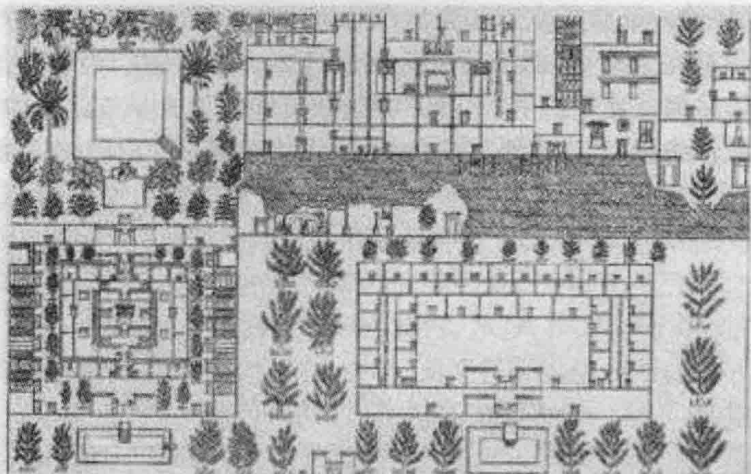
麦瑞尔 (Merire) 高级教士住所平面图
